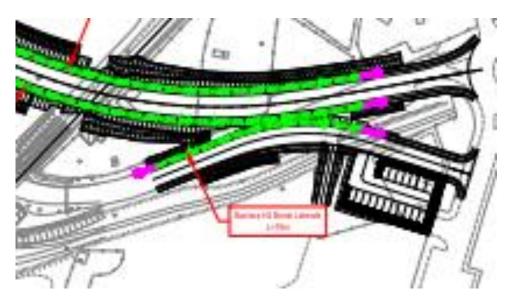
Stralcio planimetrico della tipologia di barriere lungo il tracciato della viabilità NV04.1
